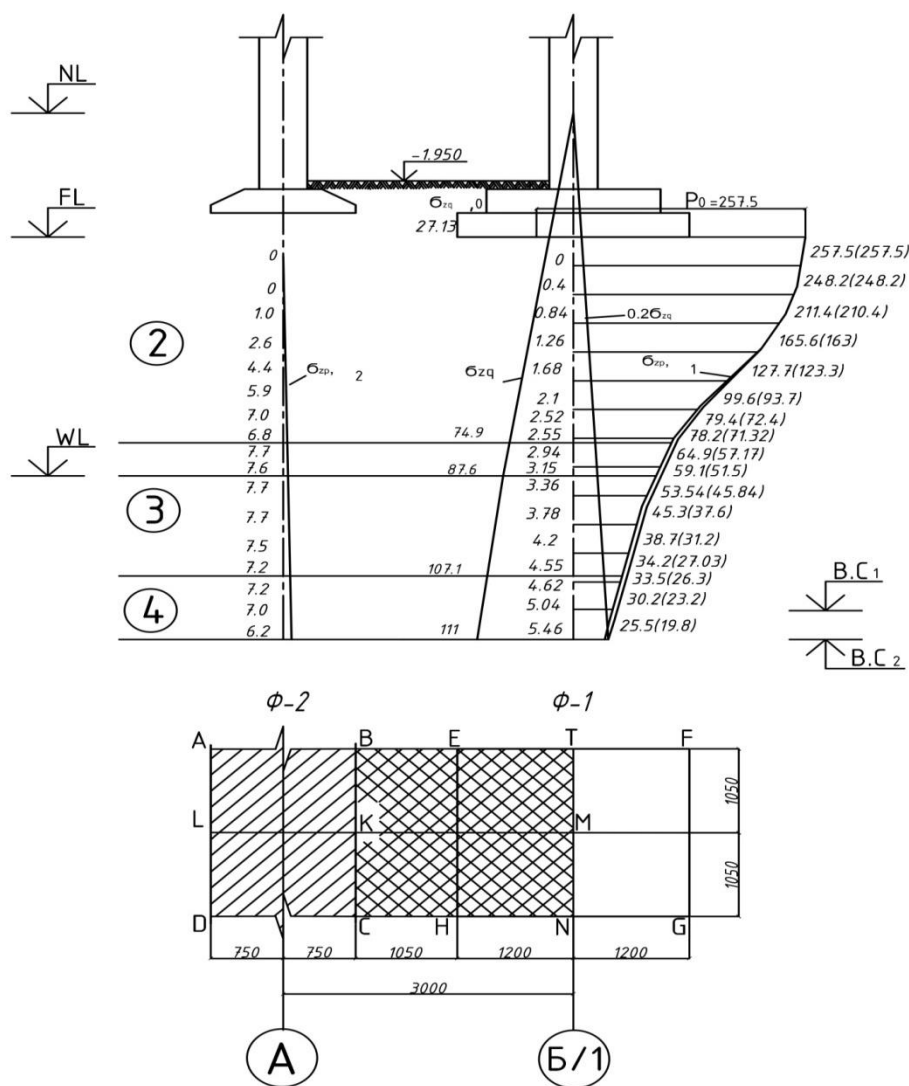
К расчету осадки фундамента Ф-1 с учетом влияния соседнего фундамента Ф-2
